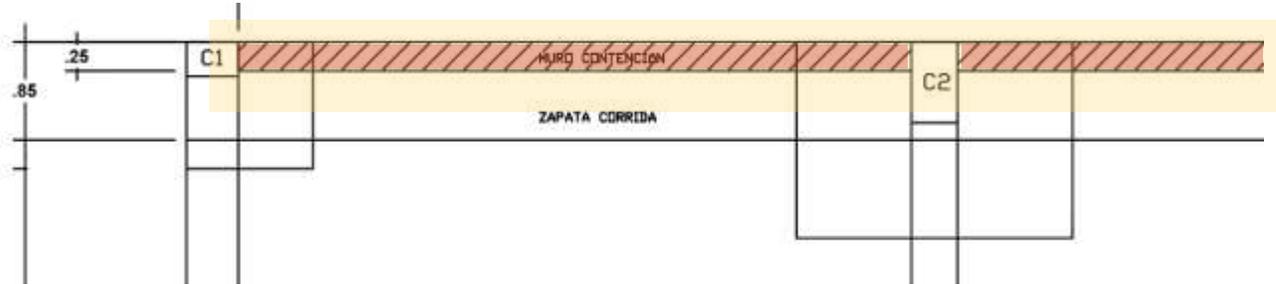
Cimiento para el muro de sótano .Ver plano 61_E02_Plano de cimentación eje B.
